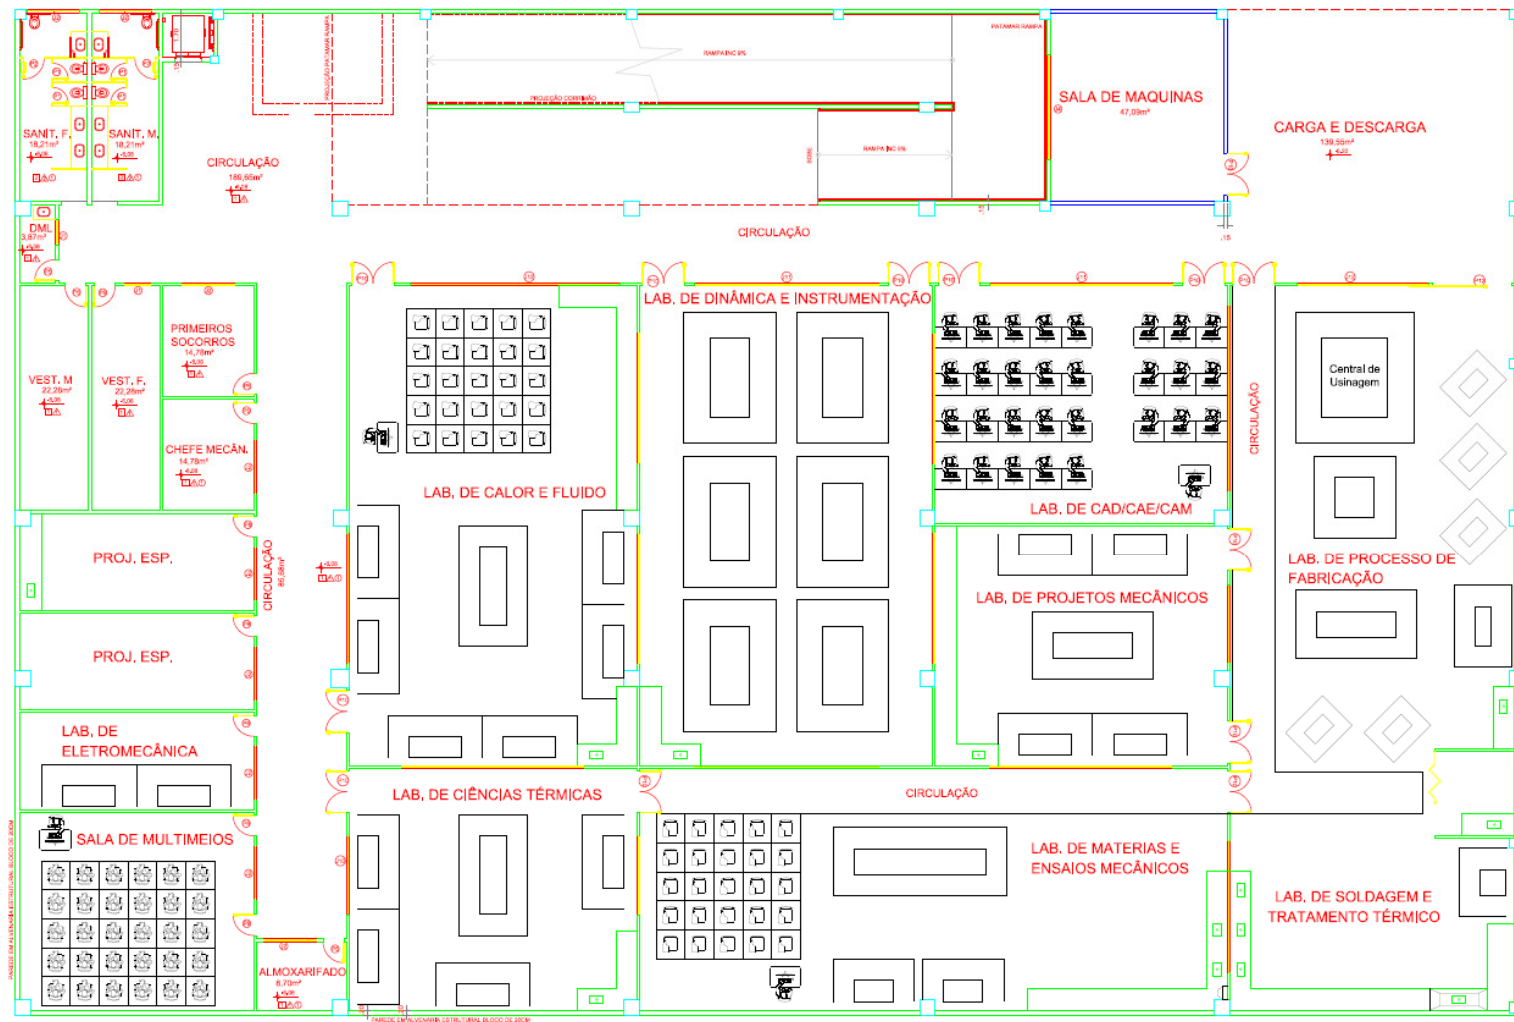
Layout do 1º Pavimento do Instituto de Tecnologia.
